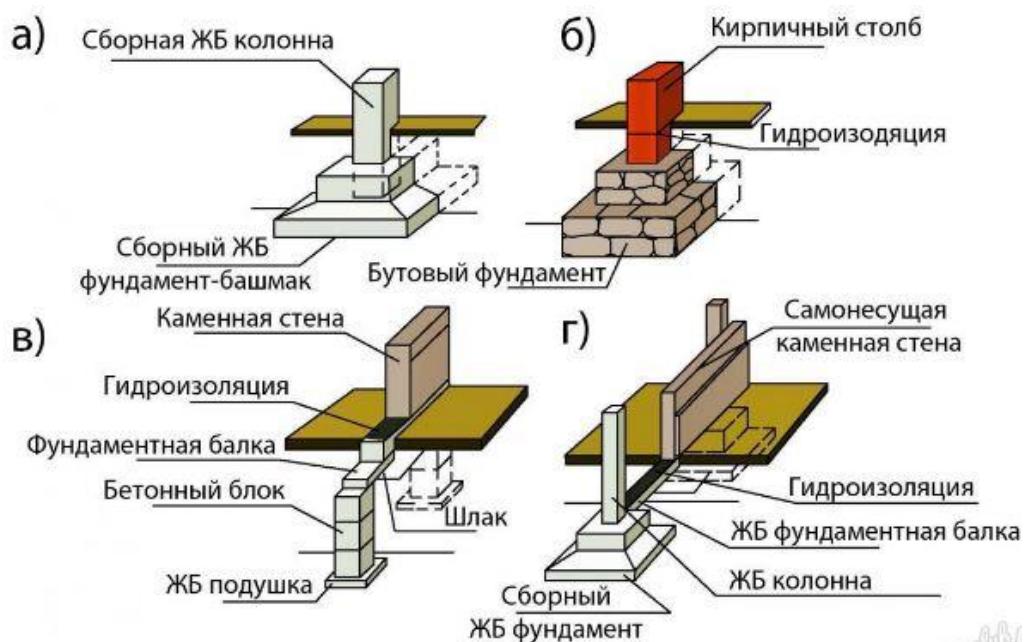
а — столбчатый фундамент под ж/б колонну; б — столбчатый фундамент под кирпичный столб; в — столбчатый фундамент под несущую стену; г — столбчатый фундамент под самонесущую стену
